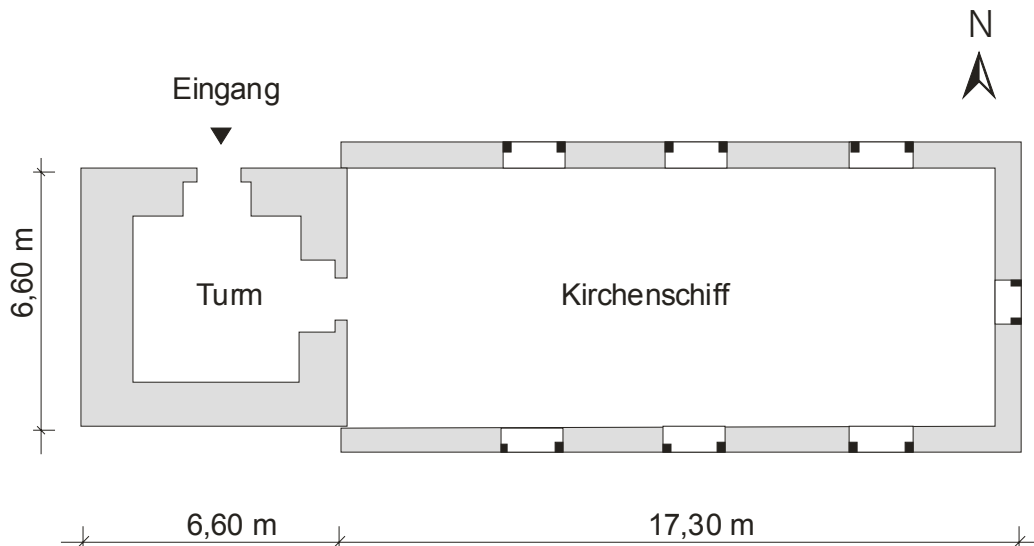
Der Grundriss des Kirchengebäudes in Gilzum
